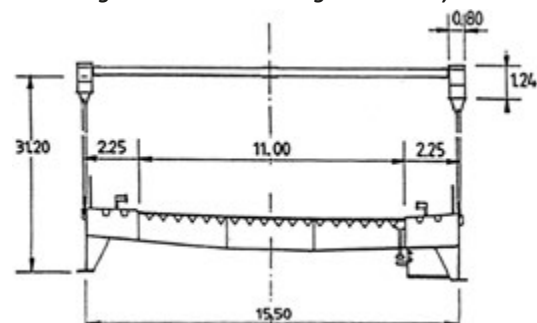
Podul Straubing – Ost. Secțiune transversală
